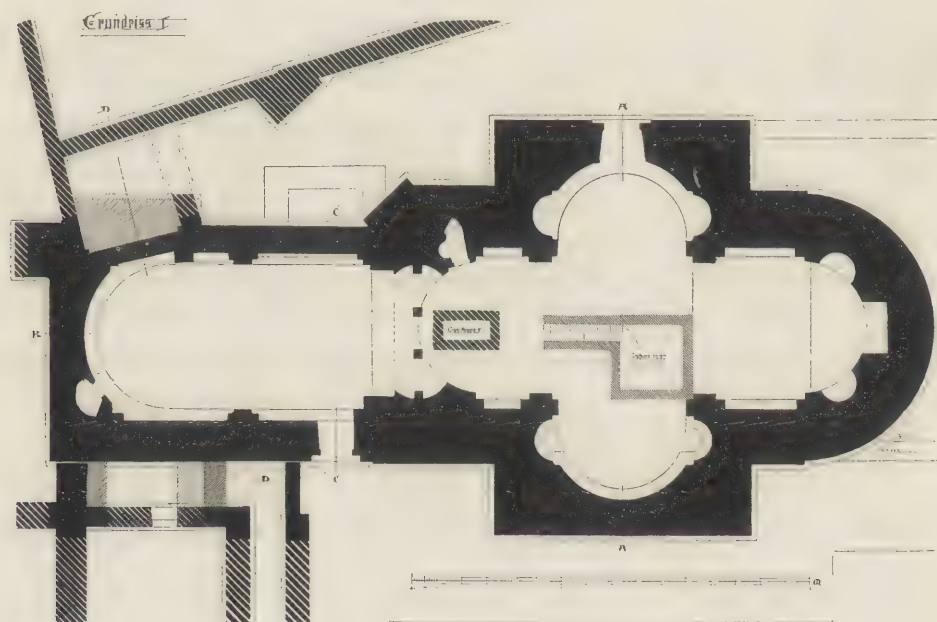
Sockel-Grundriss der Unterkirche.
